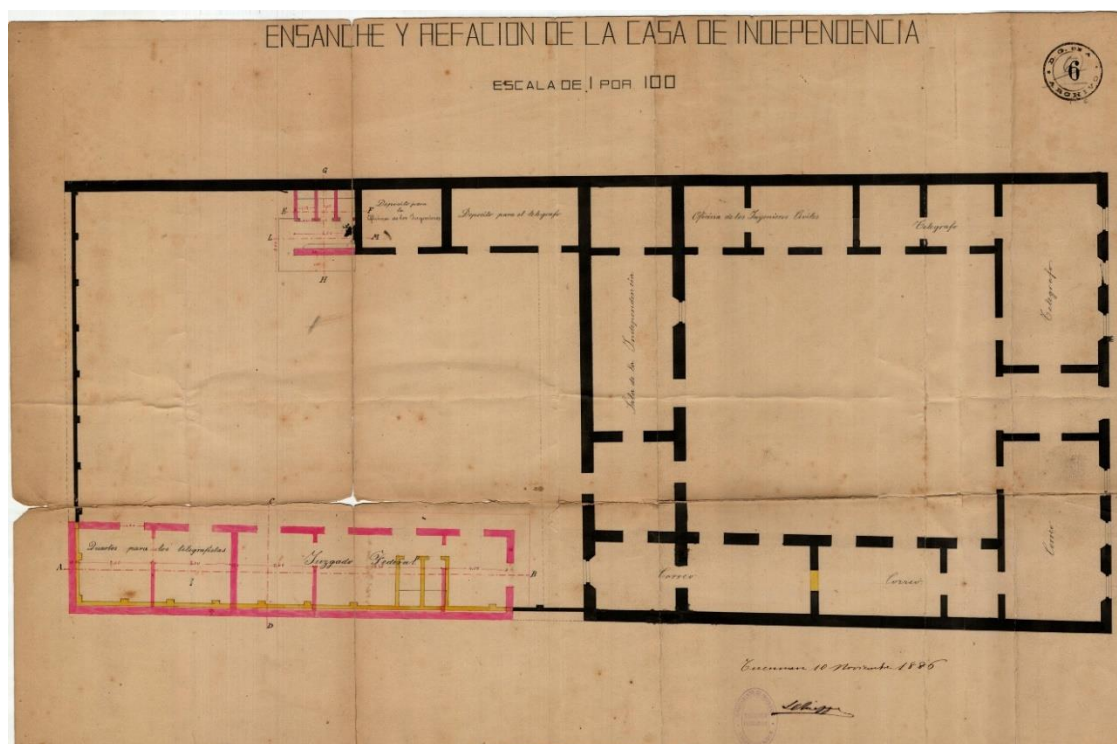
Planta Ampliación proyectada en 1886. S. Chiappe. Plano N° 6 DNOA
